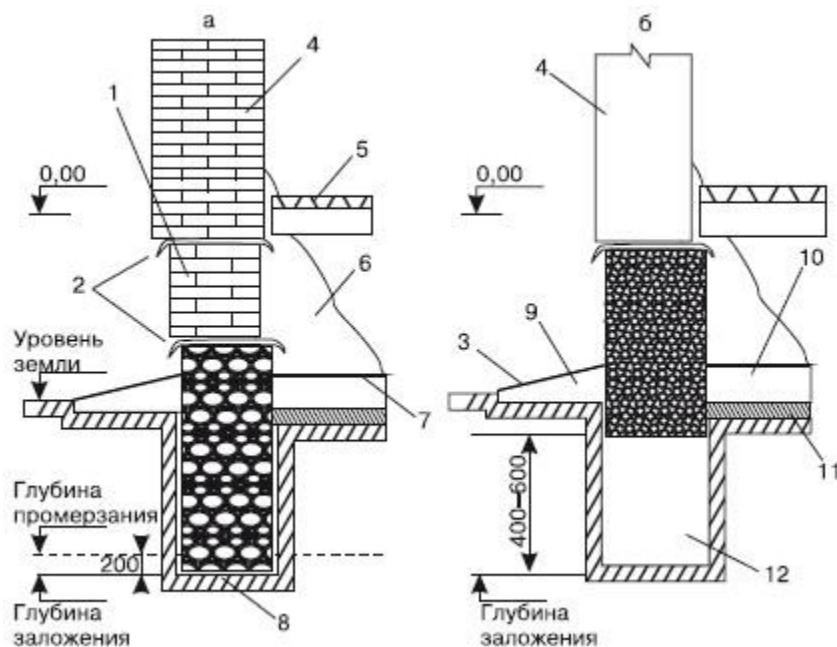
Ленточные фундаменты для бани: а – из бутового камня; б – на песчаной подушке: 1 – цоколь; 2 – гидроизоляция; 3 – отмостка; 4 – стена; 5 – доски пола; 6 – засыпка; 7 – цементная стяжка; 8 – подошва фундамента; 9 – уплотненная глина; 10 – песок; 11 – уплотненный грунт; 12 – песчаная подушка
